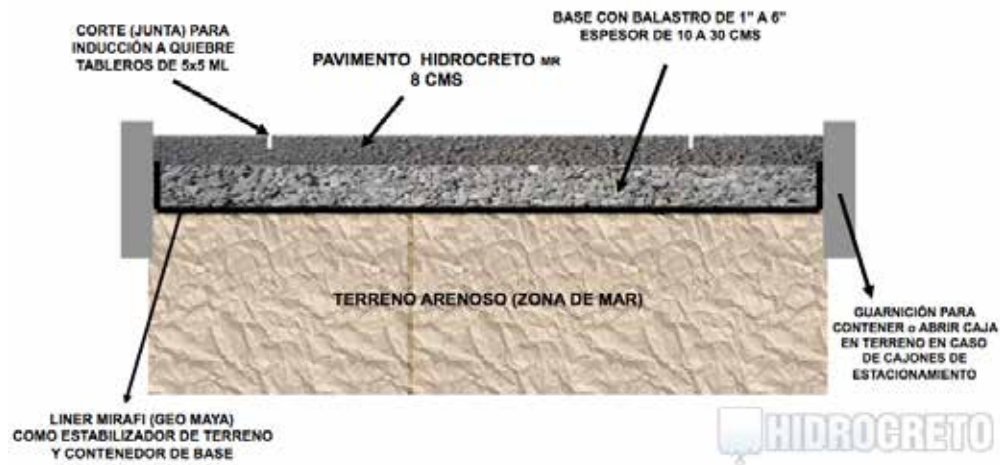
Esquema de los elementos que constituyen al sistema da pavimento permeable.
